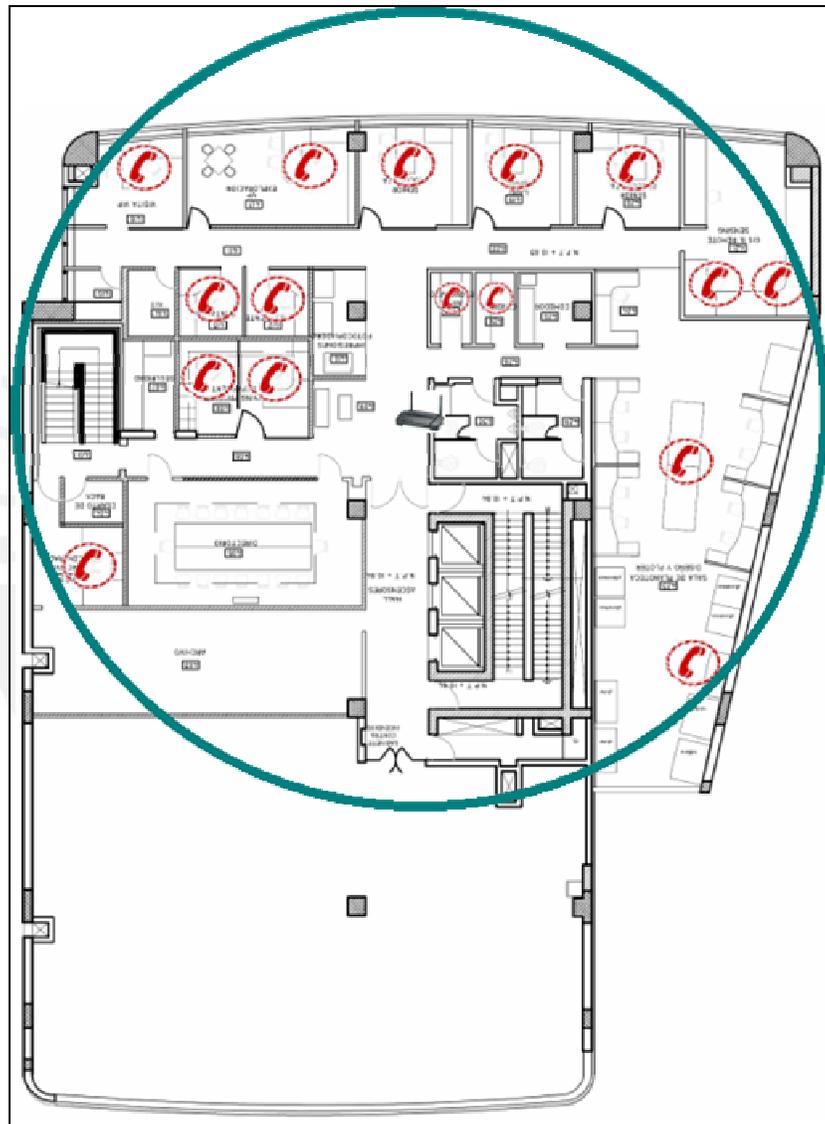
PLANO DE COBERTURA – TERCERA PLANTA
